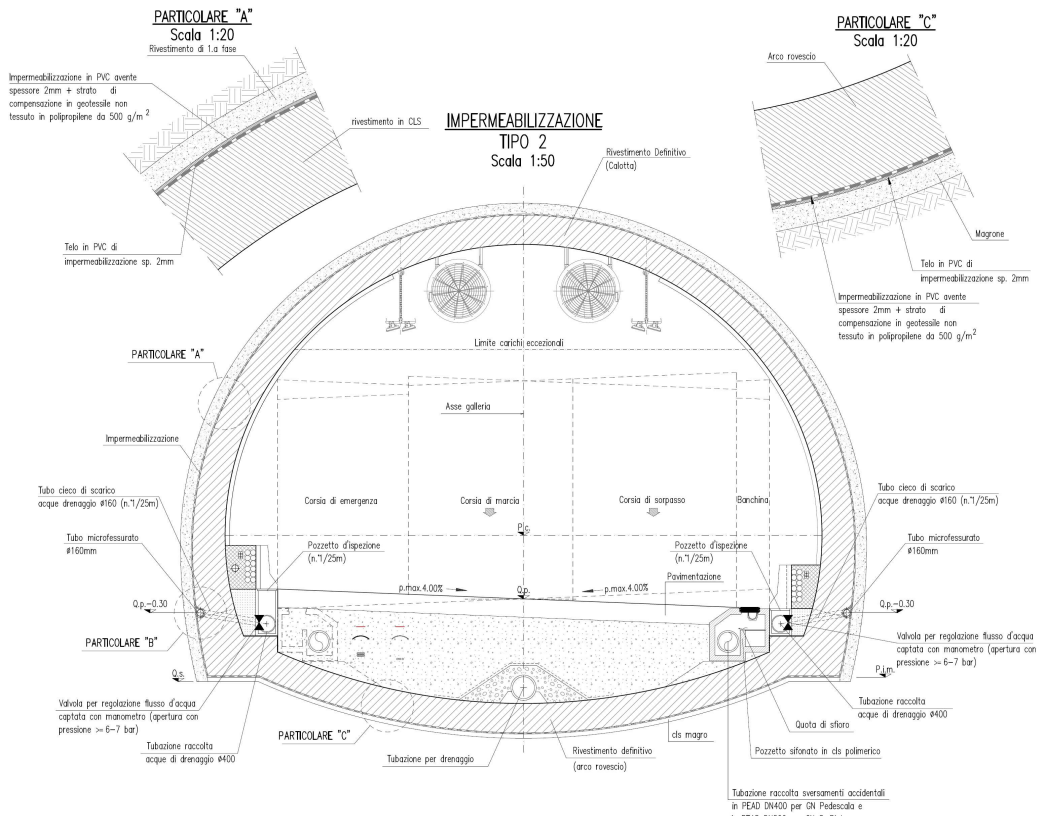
Impermeabilizzazione e drenaggio TIPO 2
